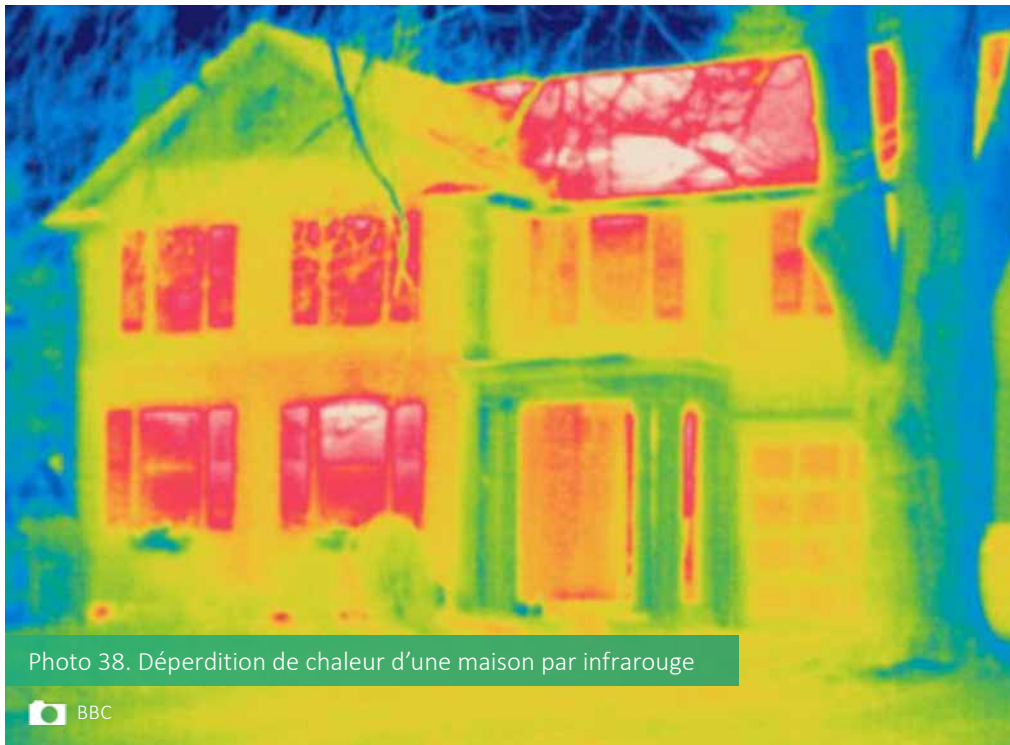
Déperdition de chaleur d'une maison par infrarouge
